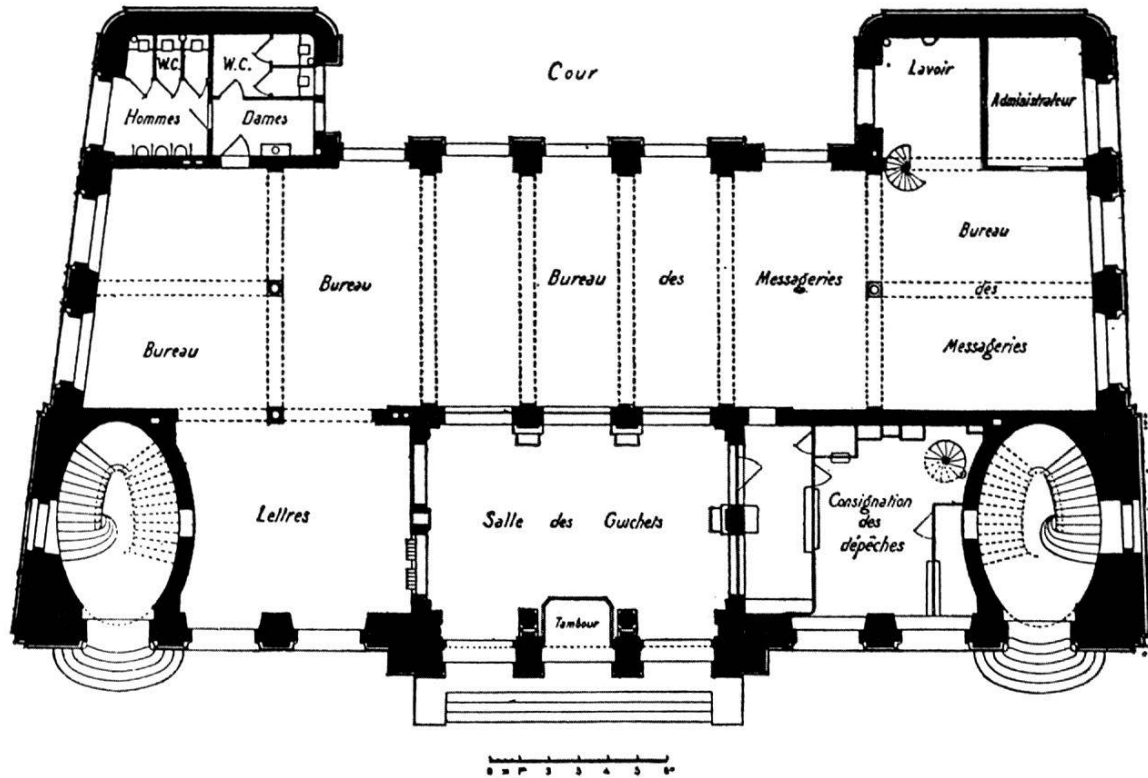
Grundriß Erdgeschoß (Album de fête 1901, S. 20).
